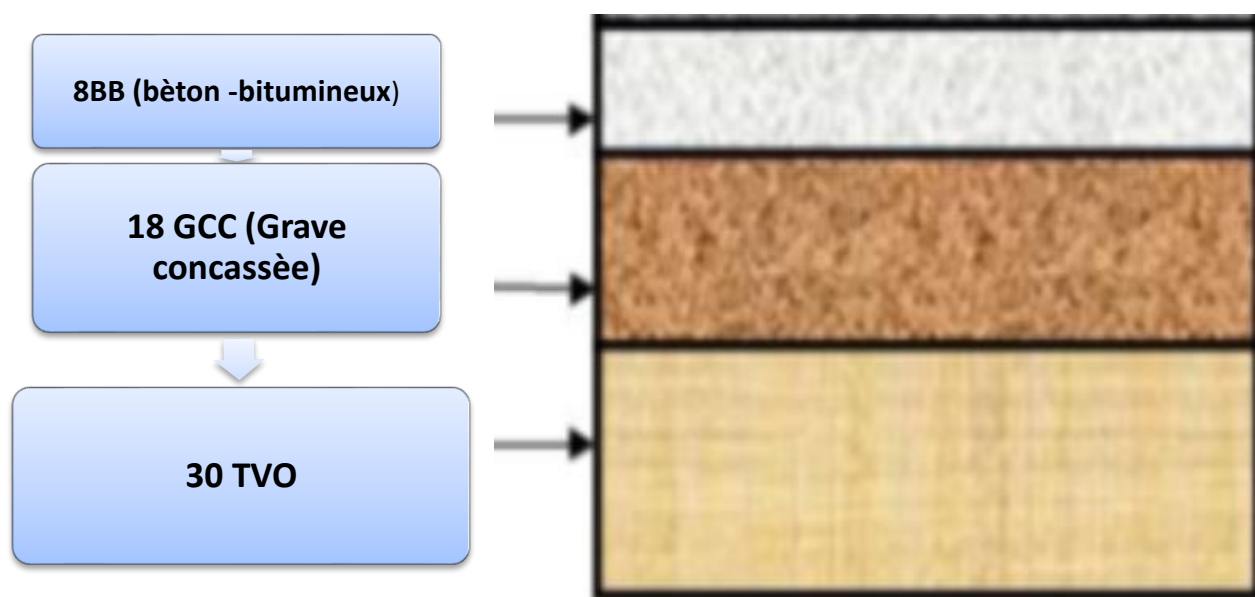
Différentes couches du corps de chaussée de la variante choisi
